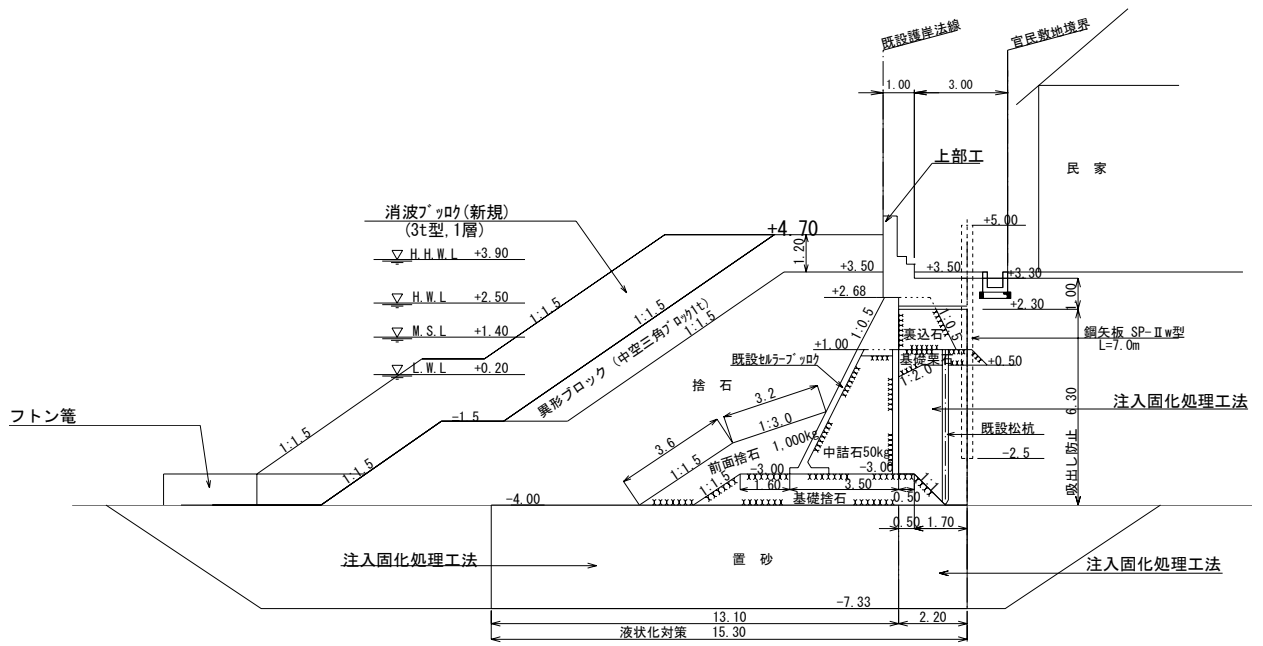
4 標準断面図 標準断面図 浜ノ町工区
